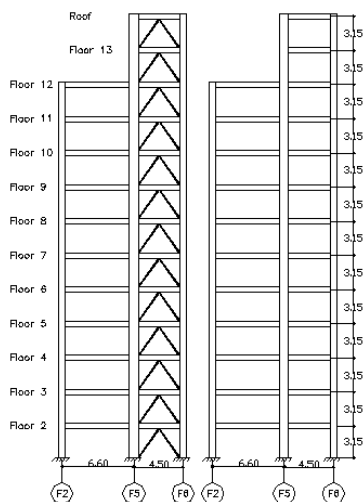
Modelo analítico de edificio de hormigón armado con riostras metálicas
